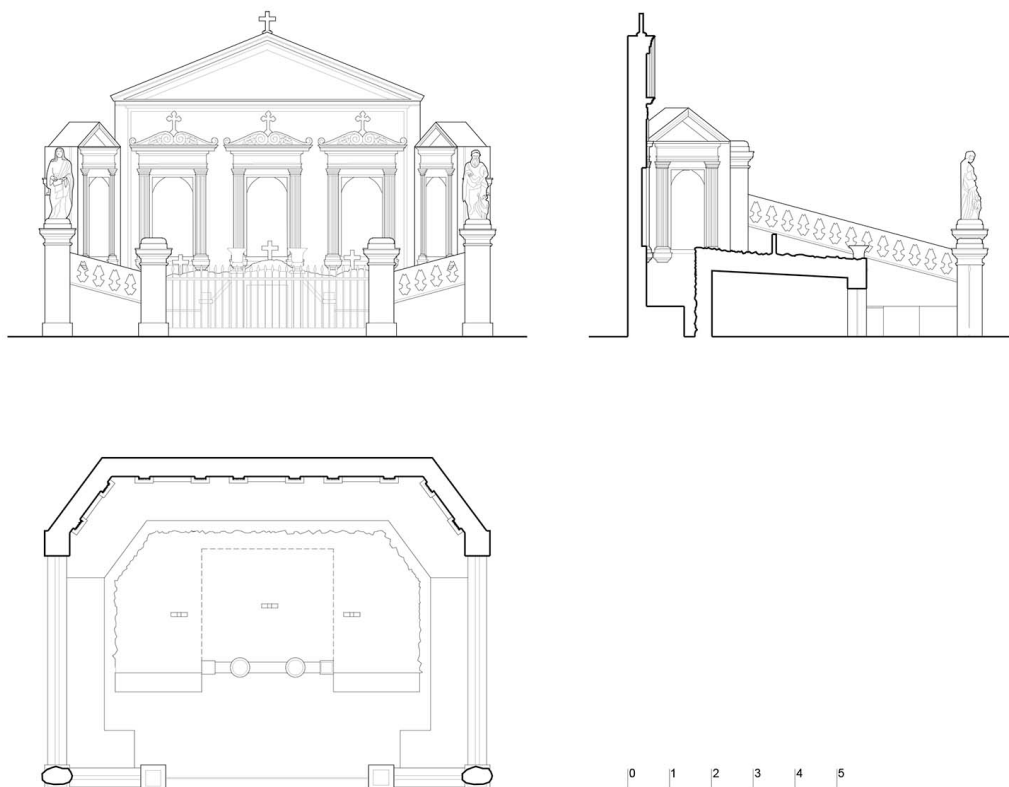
Calvario di Carovigno. Prospetto, pianta e sezione: H 7,79m x L 10,65m x P 7,95m.
